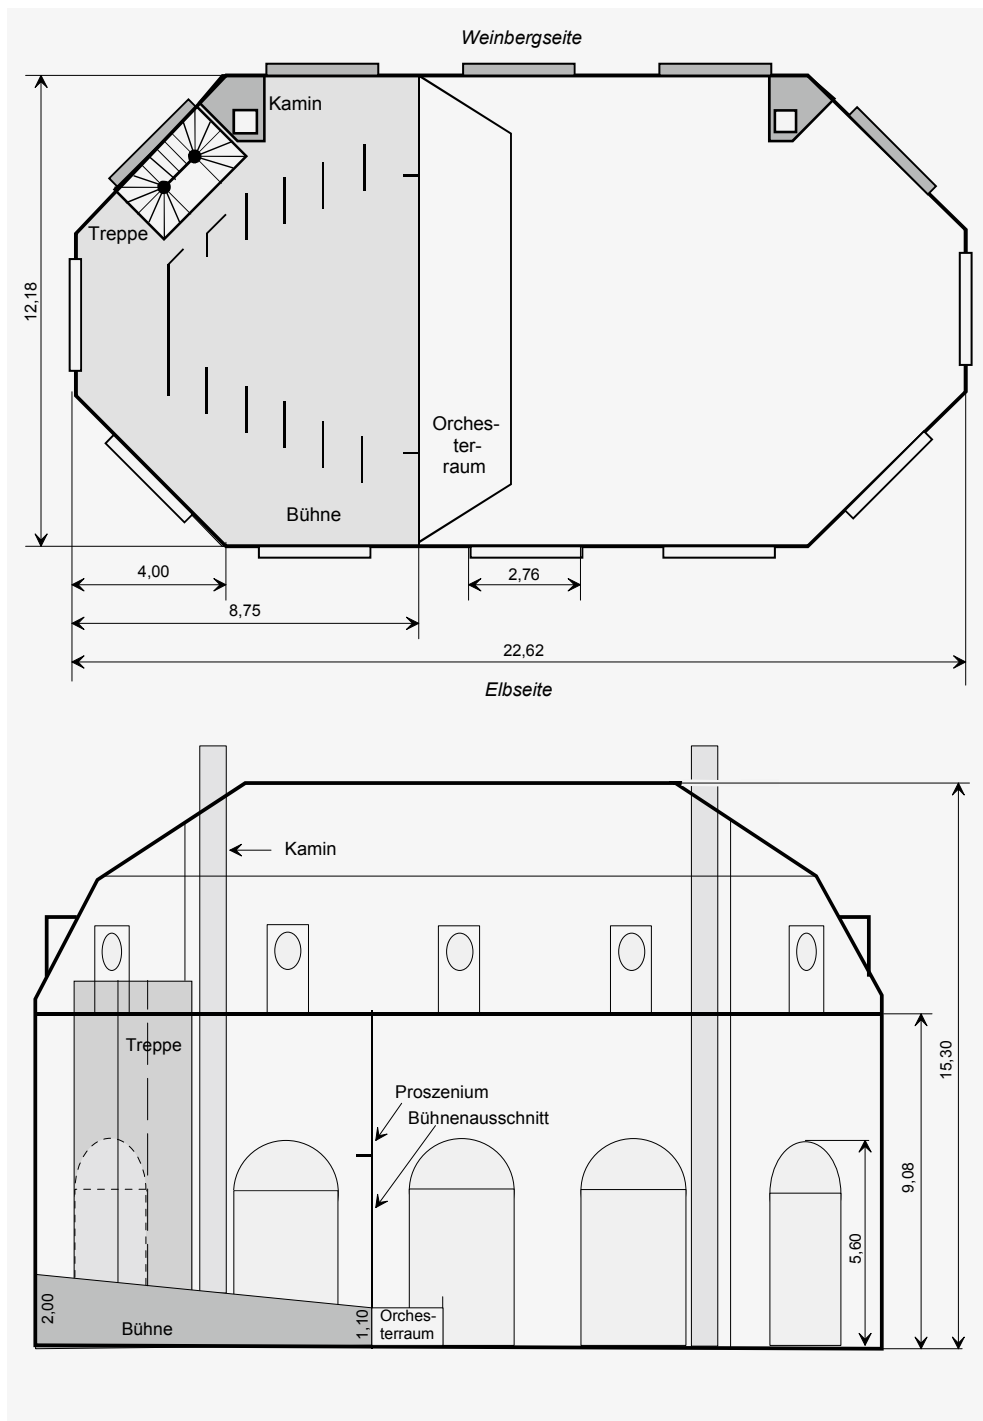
Theater im Pillnitzer Ringrennhaus; oben: Grundriss, unten: Längsschnitt.
